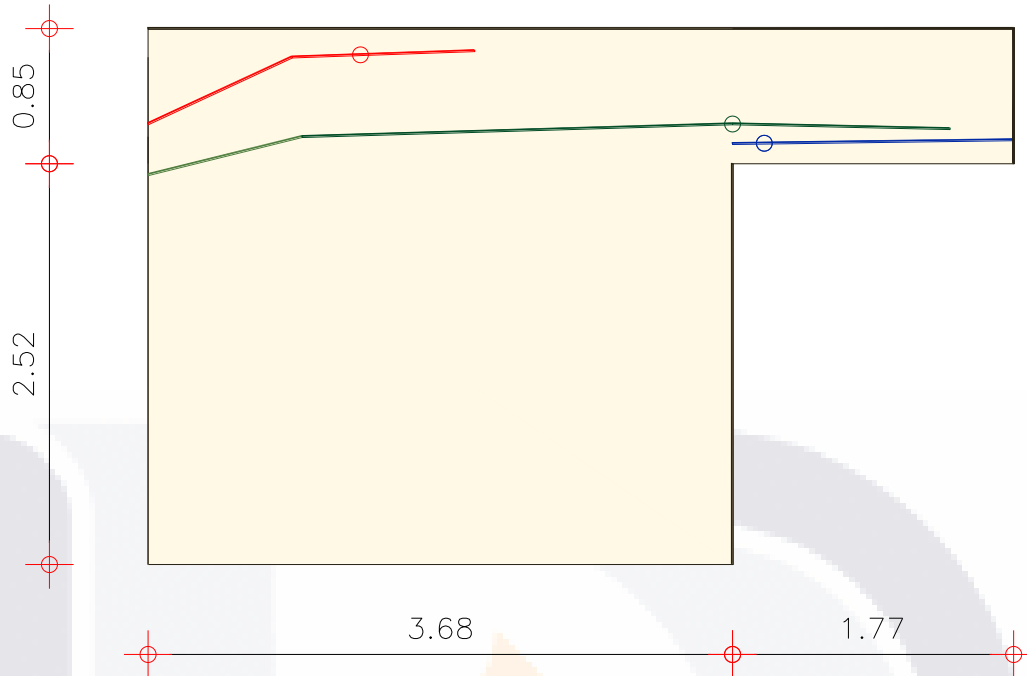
Representación de grietas en muro 33 y muro 34. La ubicación del punto donde está la abertura máxima está representada mediante un círculo.
